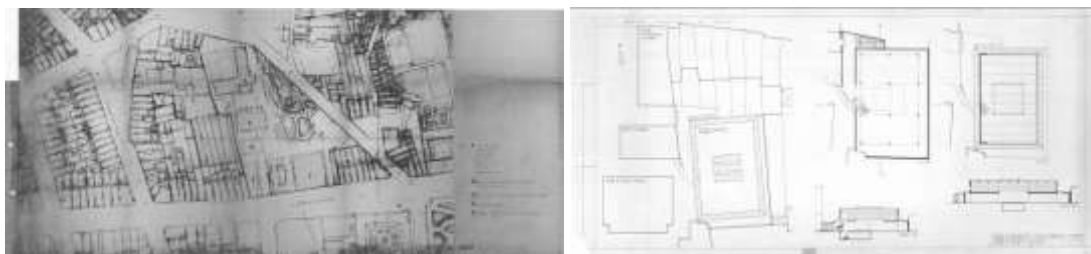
Instalações de Arquitectura - ESBAP, Planta Geral, Fev. 78. Arquivo DUP, PO-2670.
